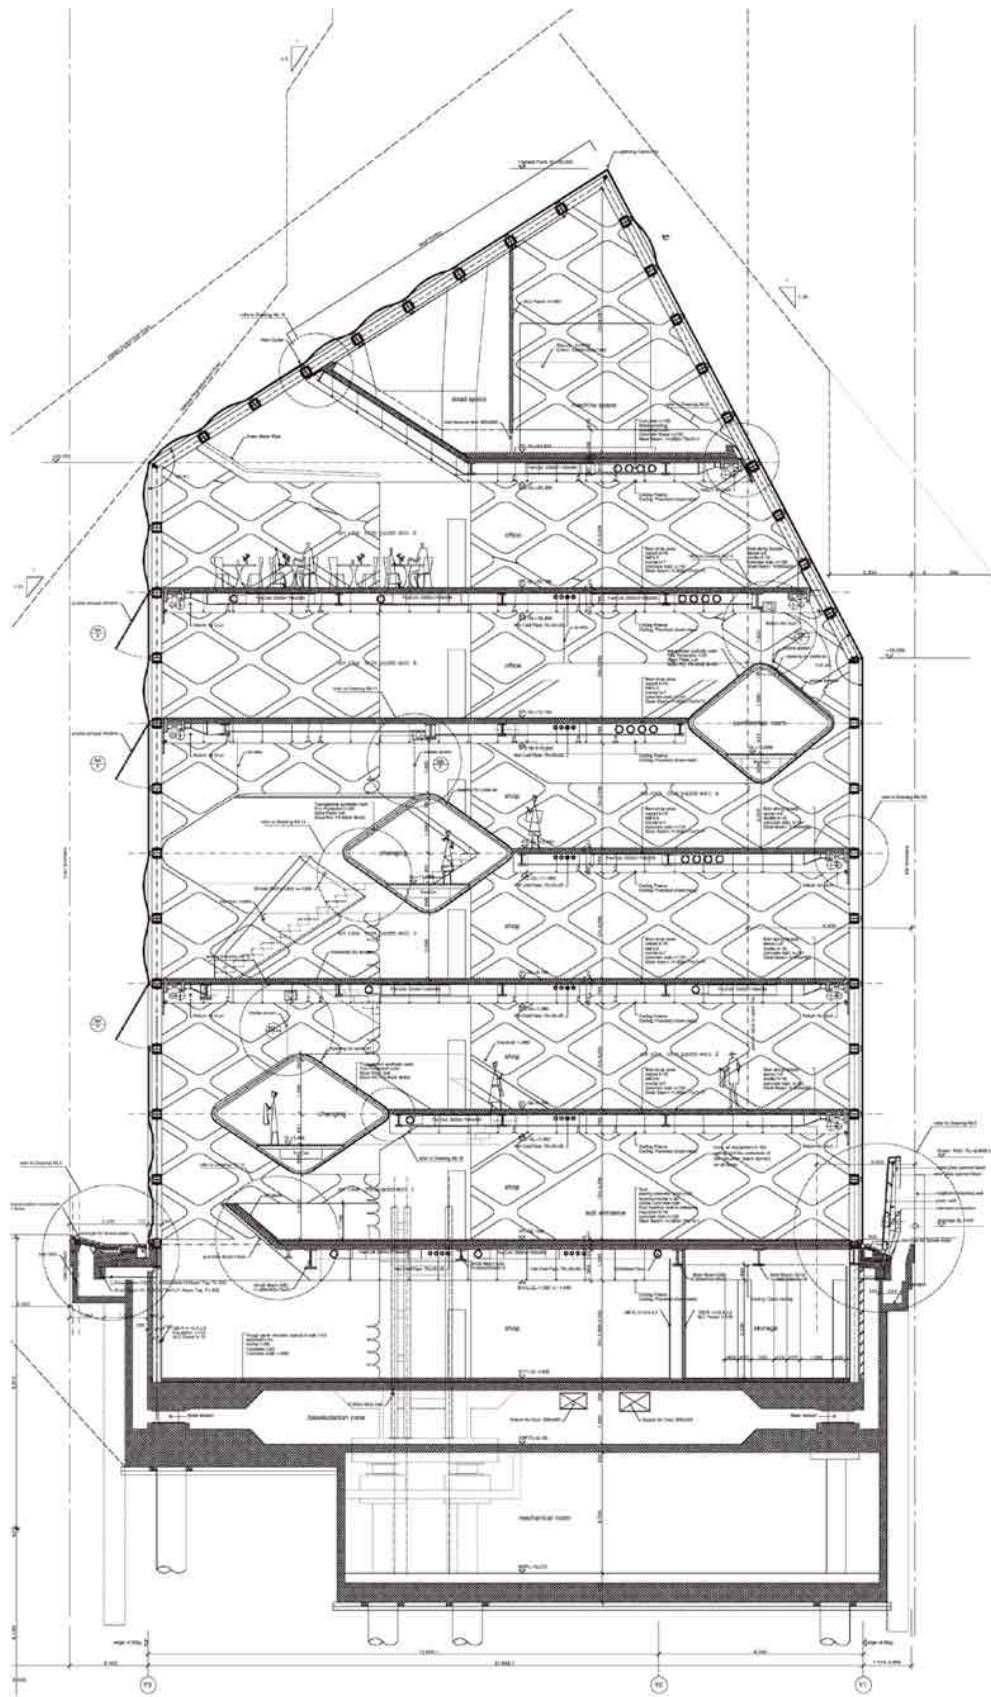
Sezione in direzione di vista Sudest a una scala d'informazione di circa 1:20 (non direttamente misurabile sull'immagine a stampa qui).
